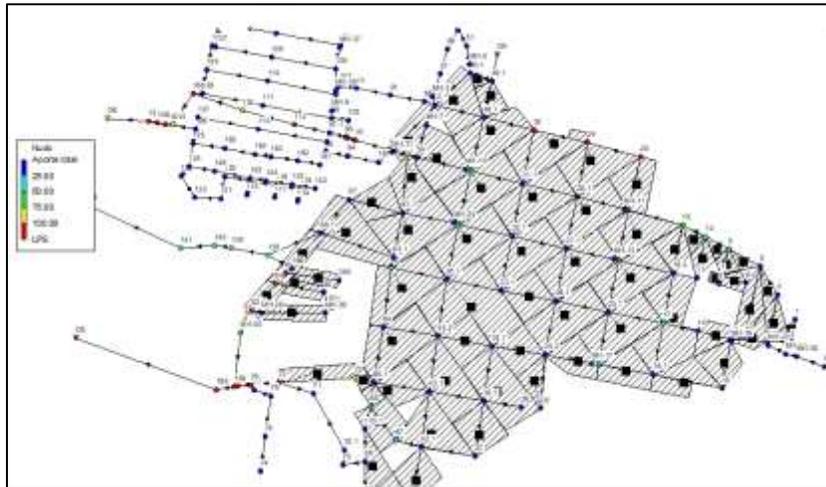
Caudal Sistema de Alcantarillado Combinado
